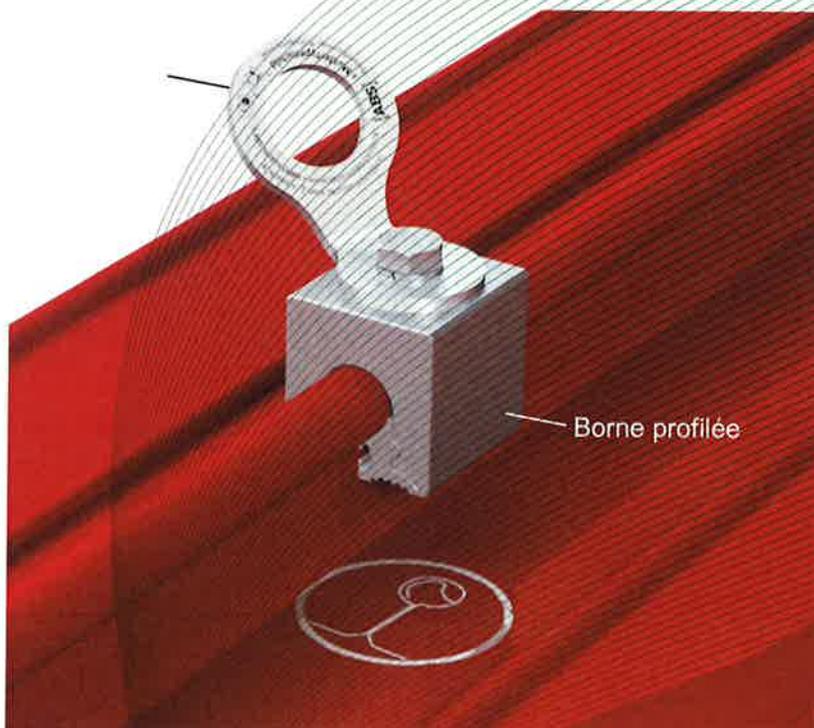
Dispositif d'ancrage, type : ABS-Lock® Falz-III (exemple de montage)
